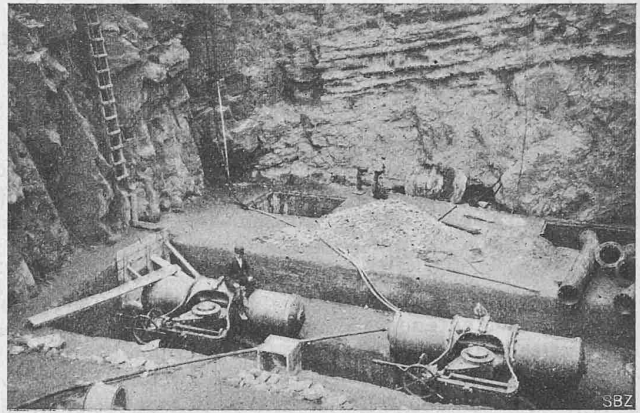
Die Druckleitungs-Gabelung, einbetoniert.
